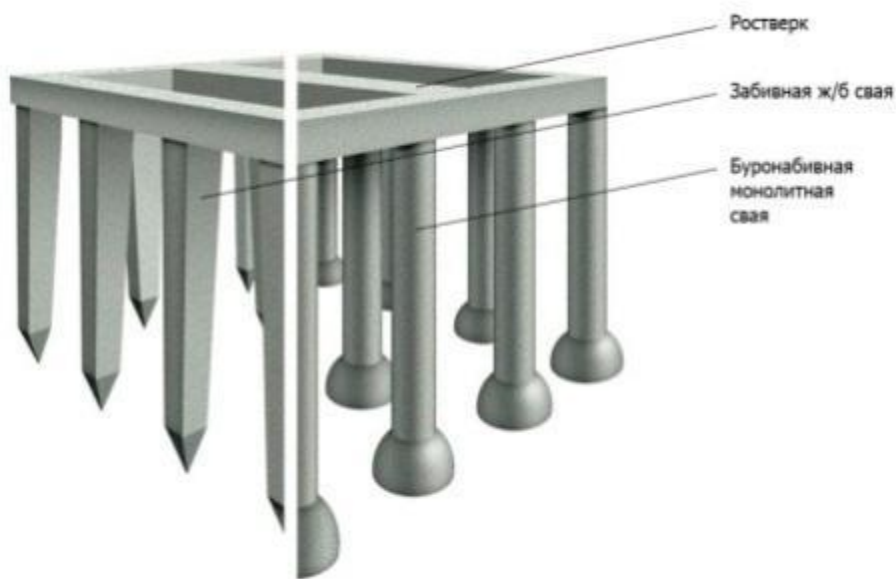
Палеві фундаменти на перехресних стрічках
